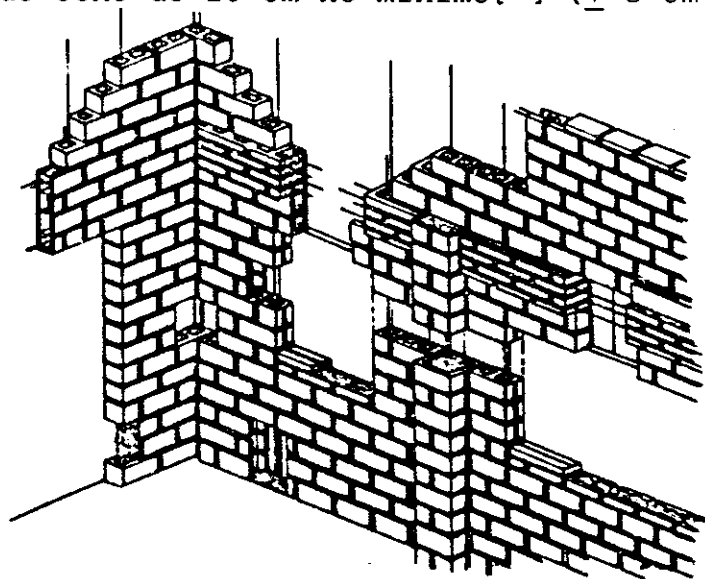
ESQUEMA DE UMA PAREDE DE ALVENARIA ESTRUTURAL [2]
